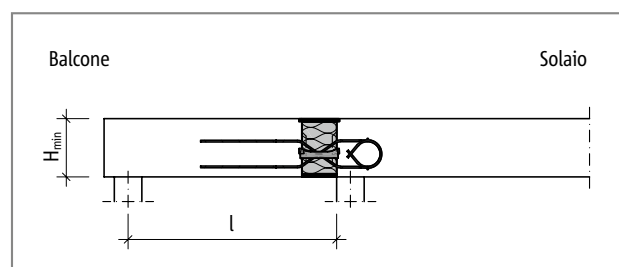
Schöck Isokorb® XT tipo QL-VV: schema statico (XT tipo QL-VV1 – VV4)
